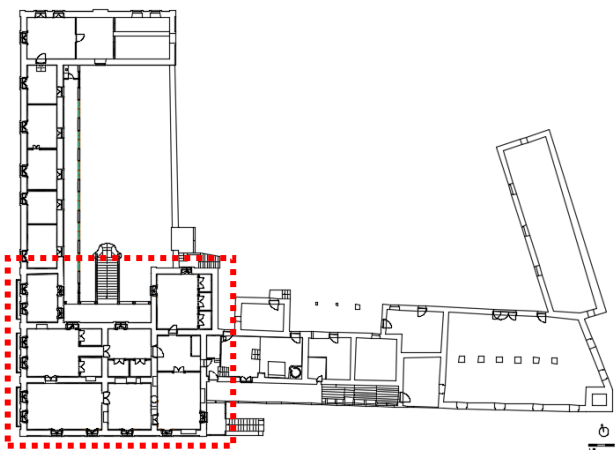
Planta do piso 1 (Primeira fase de ampliação)
